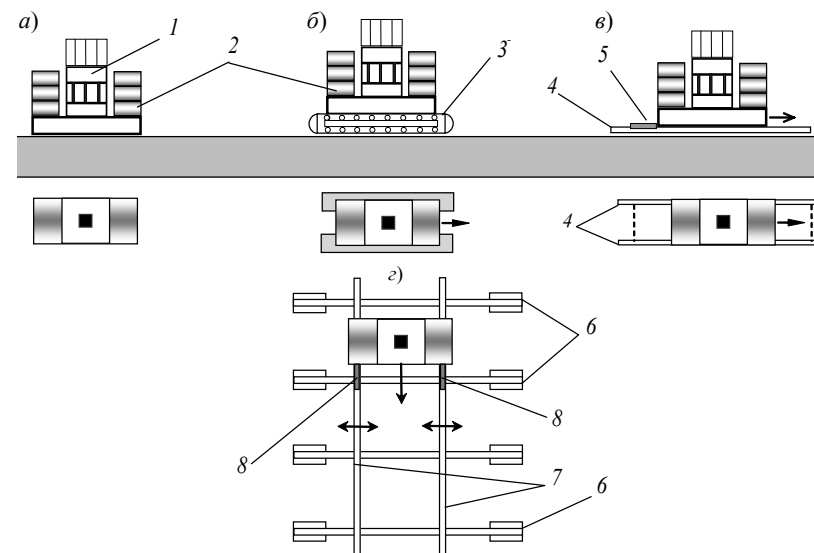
Модульная система передвижения УВС: а – установка на каждую сваю переставляется краном; б, в, г – установка на ходовых устройствах в виде гусеничного и рельсового хода, модульных перекрестных балках соответственно; 1 – УВС; 2 – инвентарные пригрузы; 3 – гусеничный ход; 4 – рельсы; 5, 8 – гидроцилиндры перемещения УВС; 6 – продольные неподвижные балки; 7 – поперечные подвижные балки
